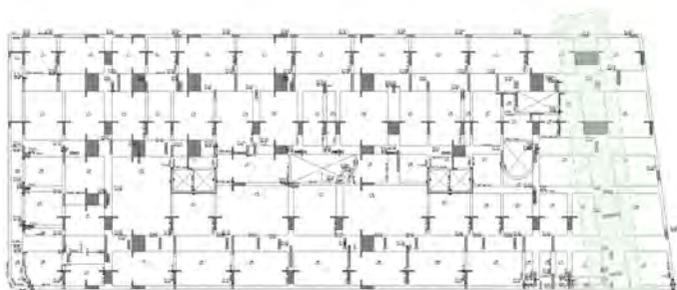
Pavimento tipo com destaque para a viga de transição analisada
